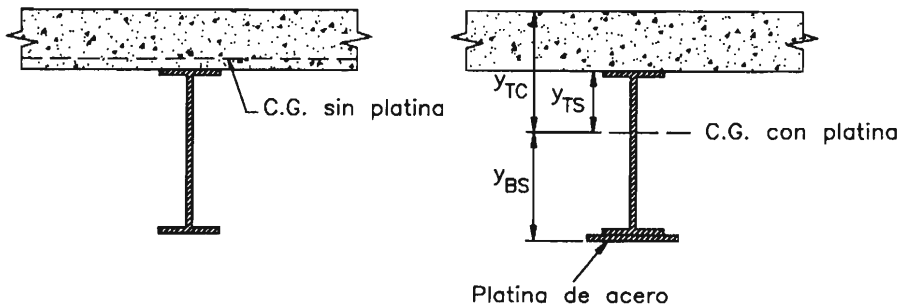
Platinas soldadas en la base del perfil metálico para hacer descender el eje neutro de la sección compuesta
